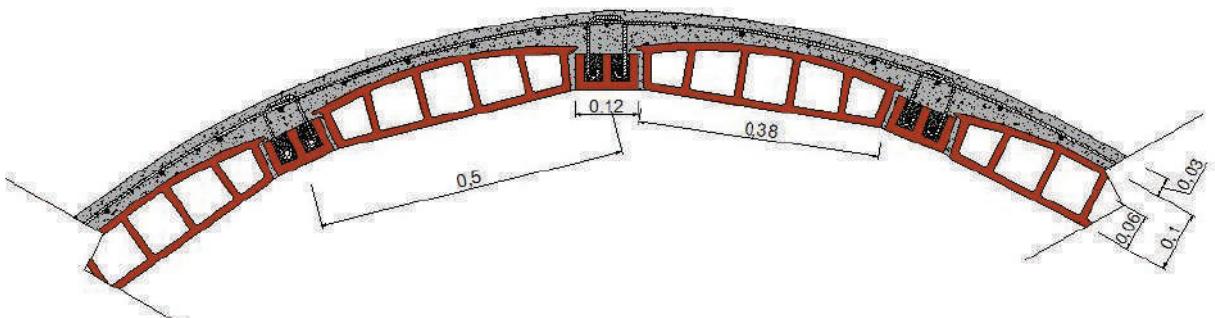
Abóbadas com vigotas Stalton. Detalhe - corte transversal. (*-5).
